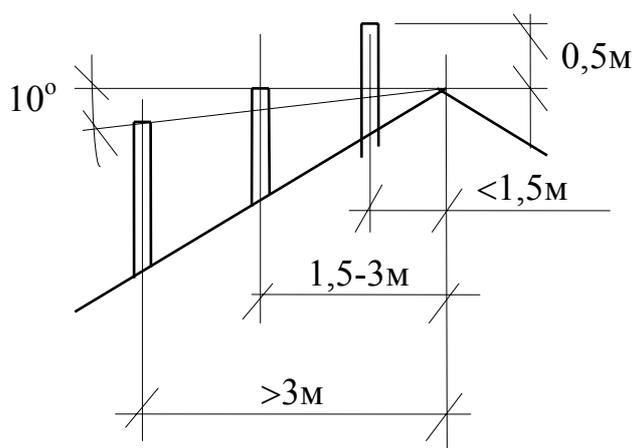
Высота шахты естественной вытяжной вентиляции над кровлей
